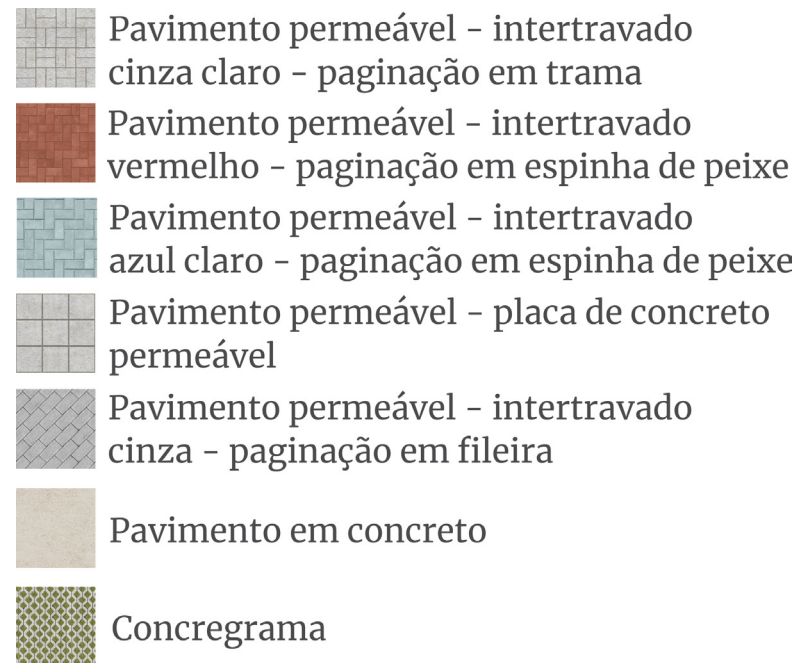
Tipos de pavimentos utilizados no projeto. Fonte: edição própria..
